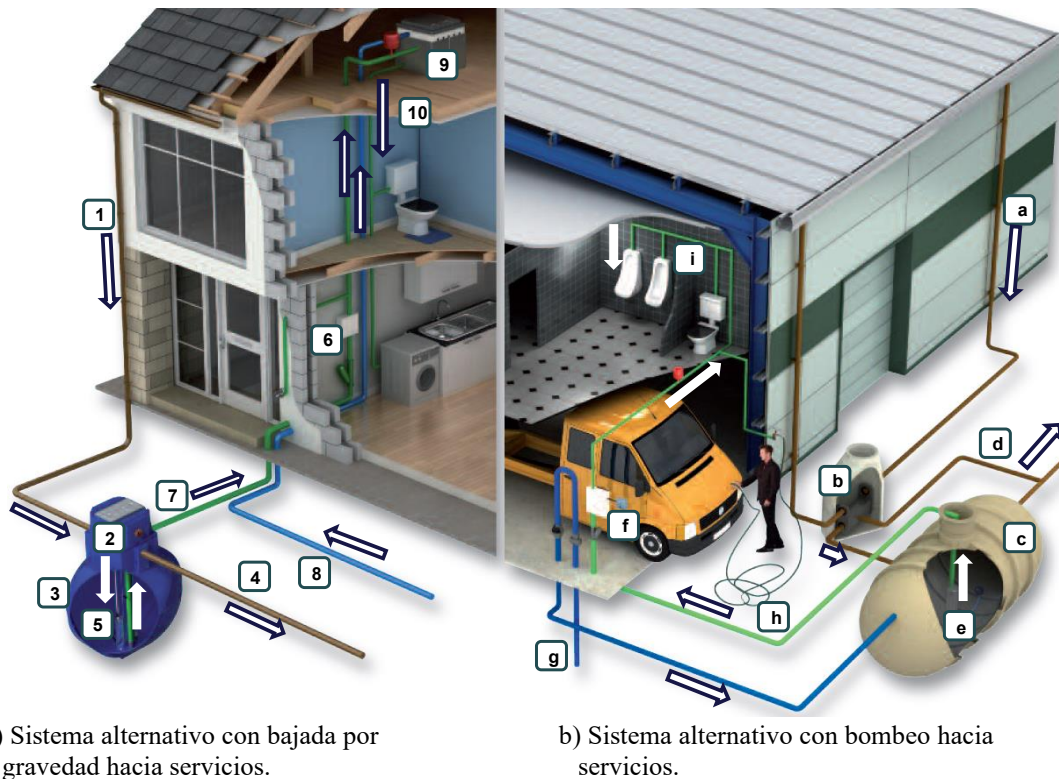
Sistemas para uso alternativo de agua de lluvia en WC, lavado de ropa y automóviles. Fuente: Kingspan, (2009)
